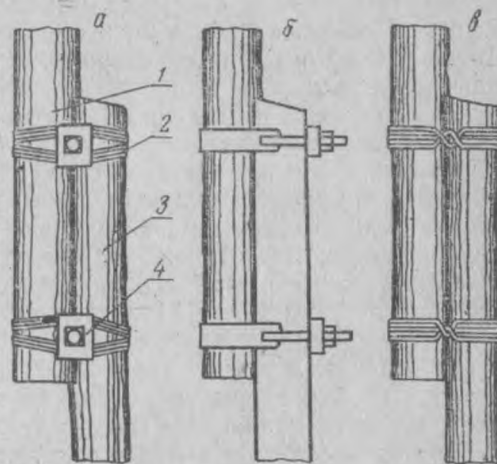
Соединение стойки с пасынком: а — проволочными бандажными со стяжными болтами, б — припасовочными хомутами, в — проволочными бандажными
